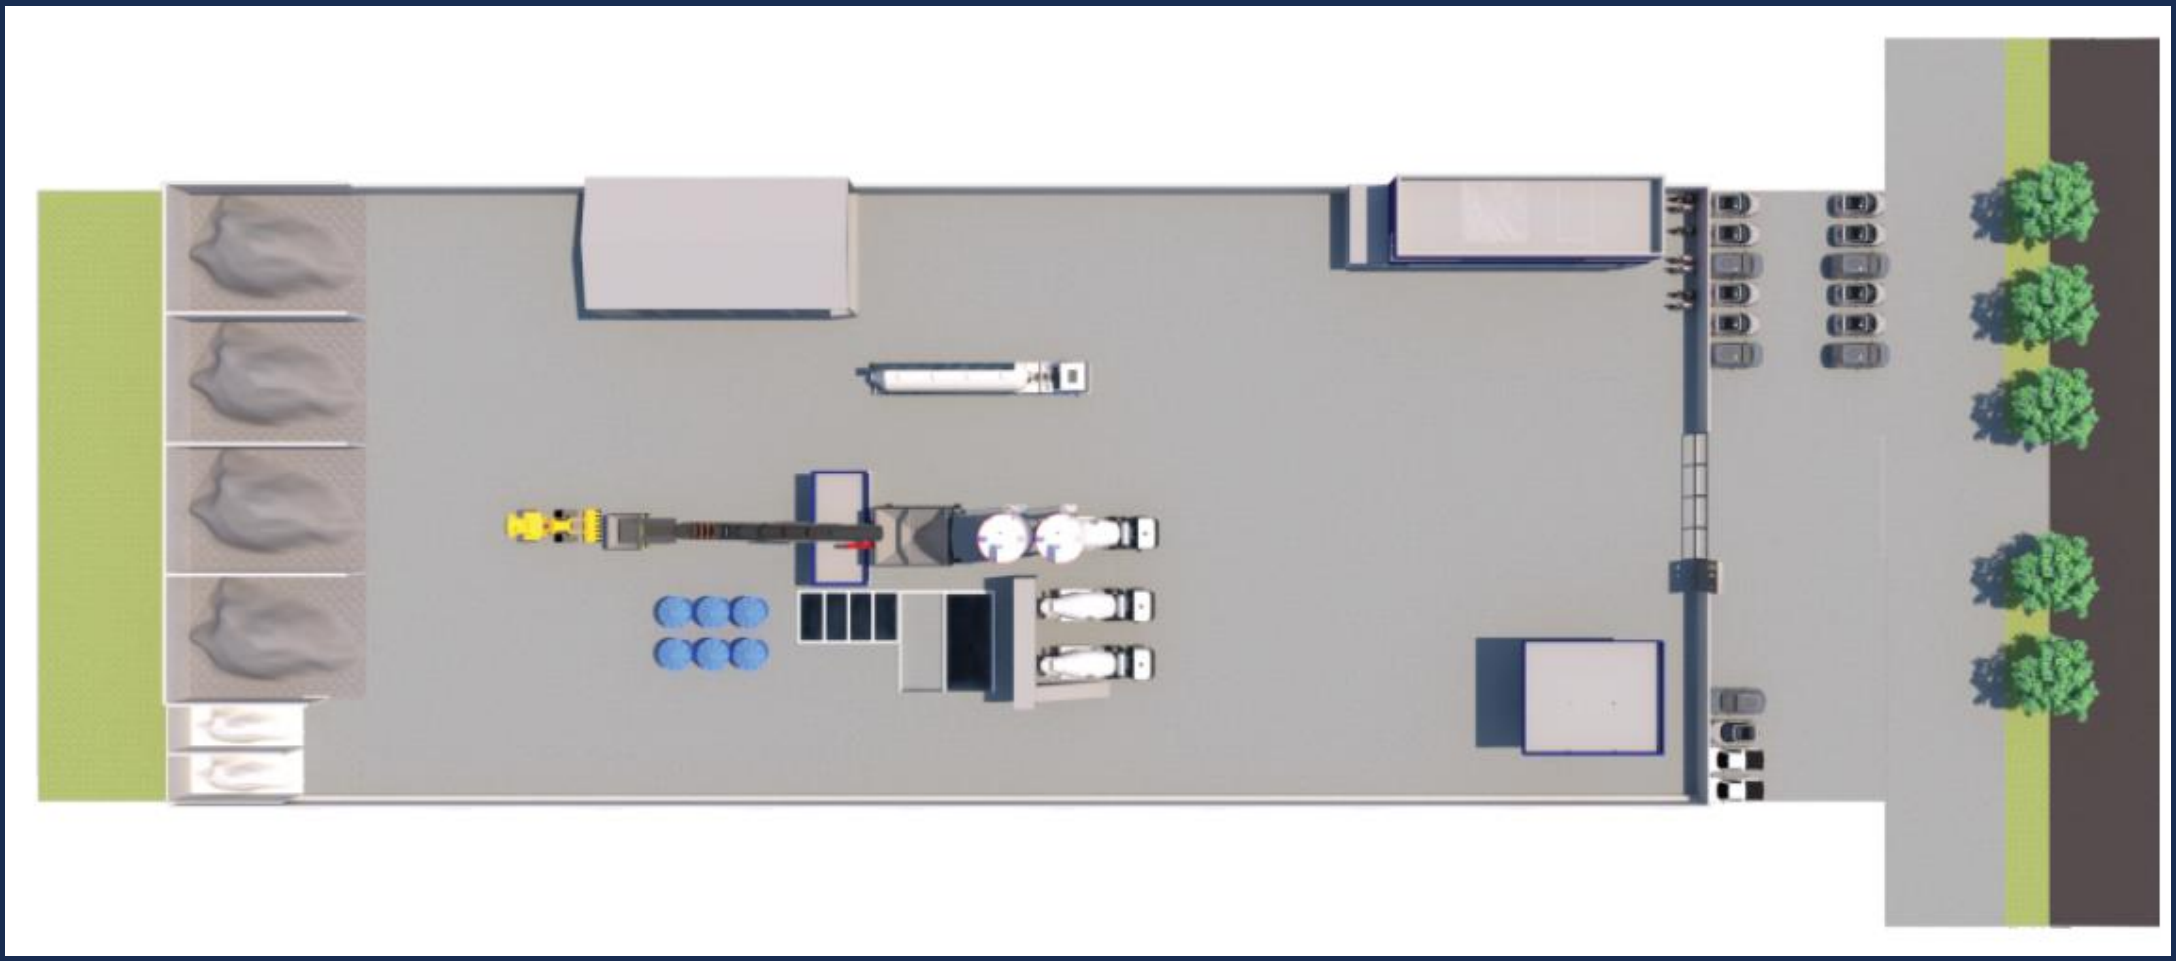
ilustração da planta BAIXA DO TÉRREO. Fonte: Projeto arquitetônico.
